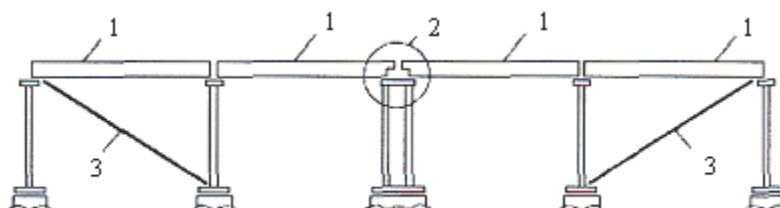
Усиление металлических балок с помощью распорного устройства:
